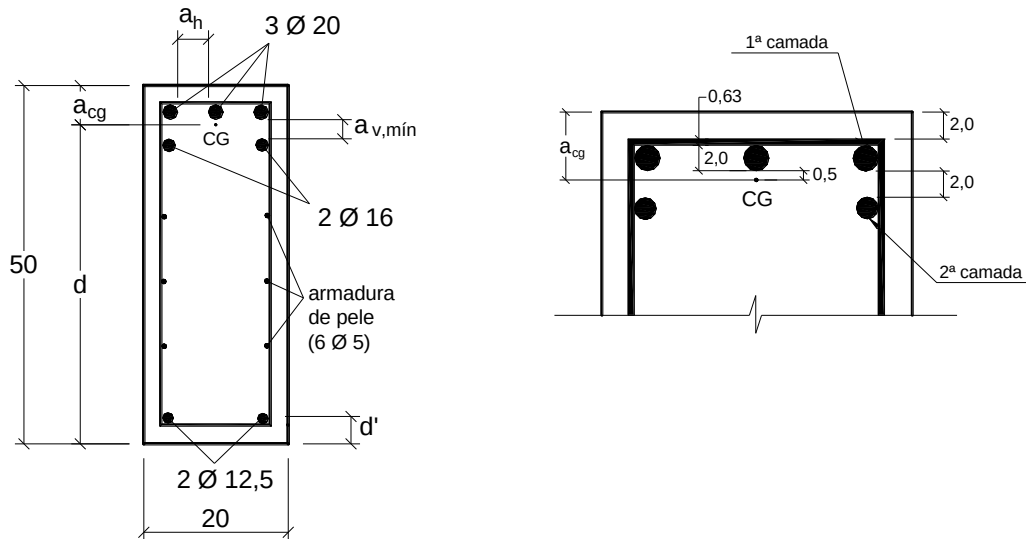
Detalhamento das armaduras longitudinais de flexão na seção transversal.
